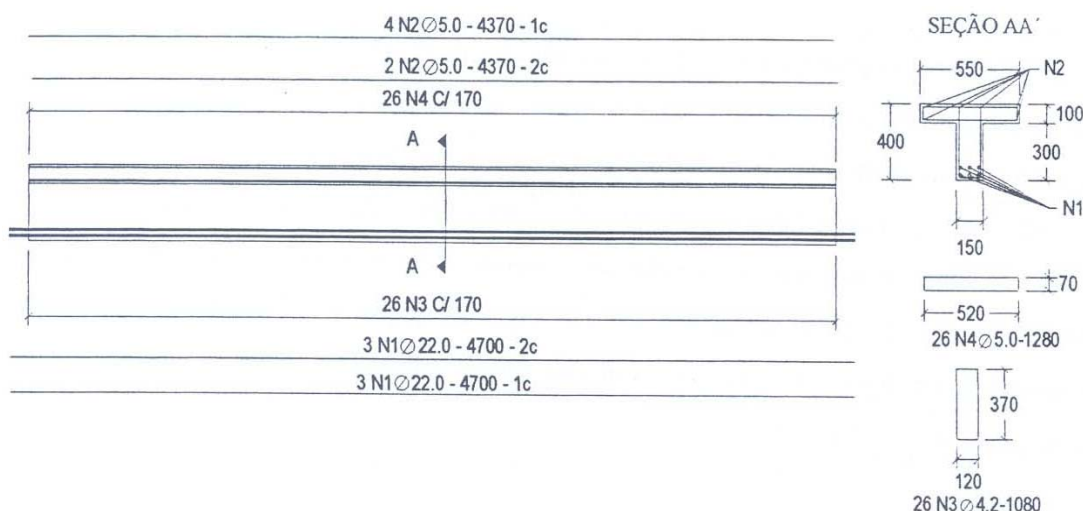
Detalhamento das armaduras do grupo 2; adaptada de Araújo (2002).
